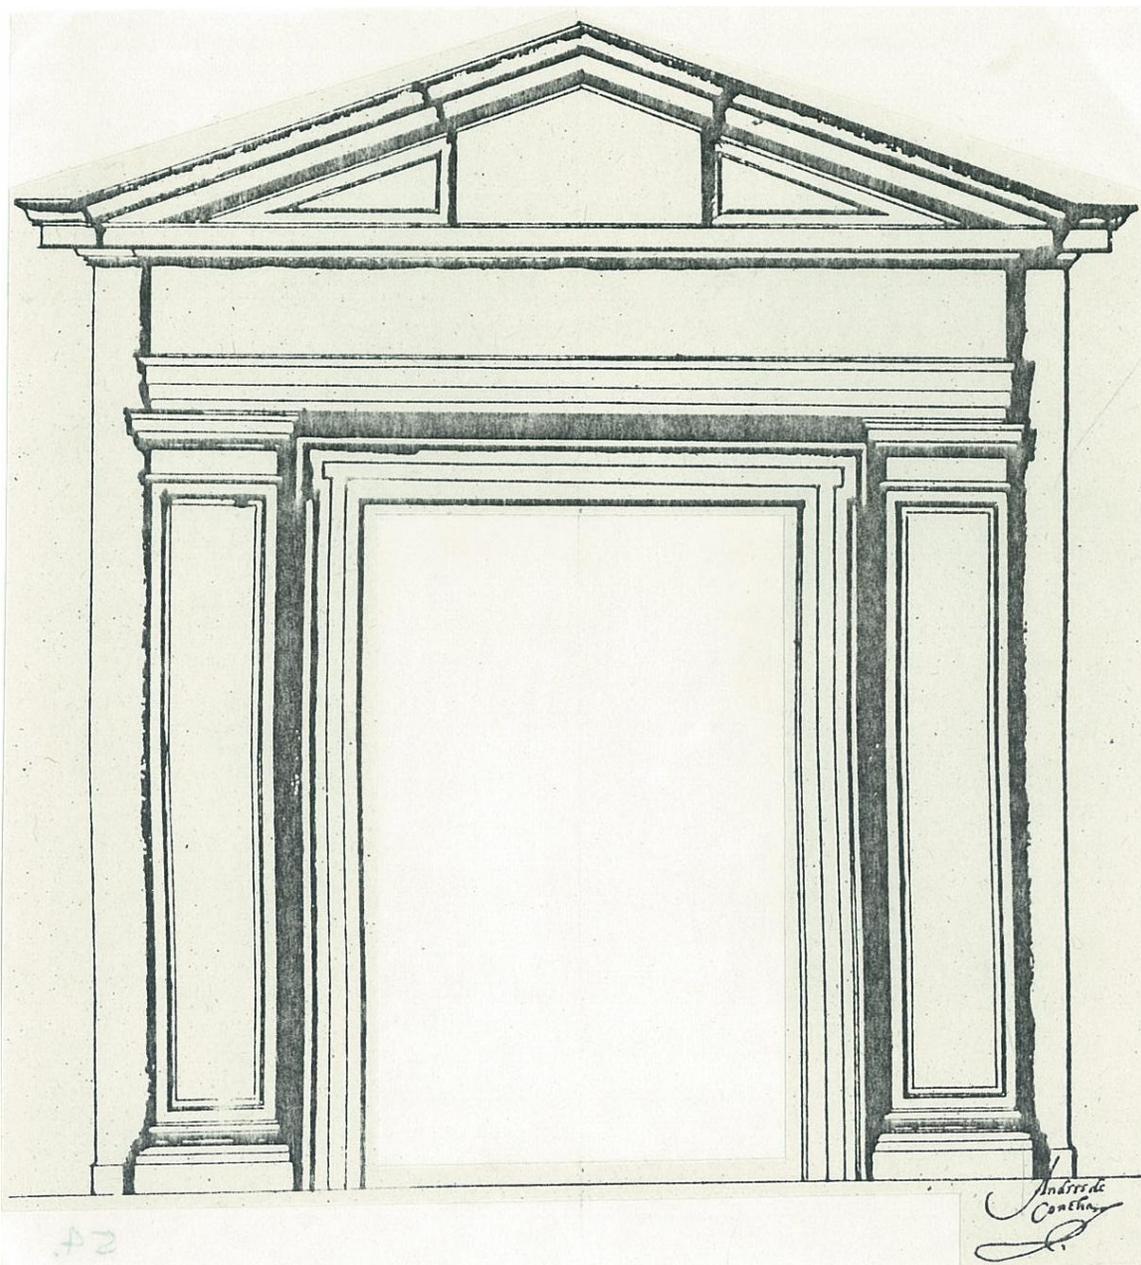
Alzado arquitectónico, de fray Andrés de San Miguel (16)
